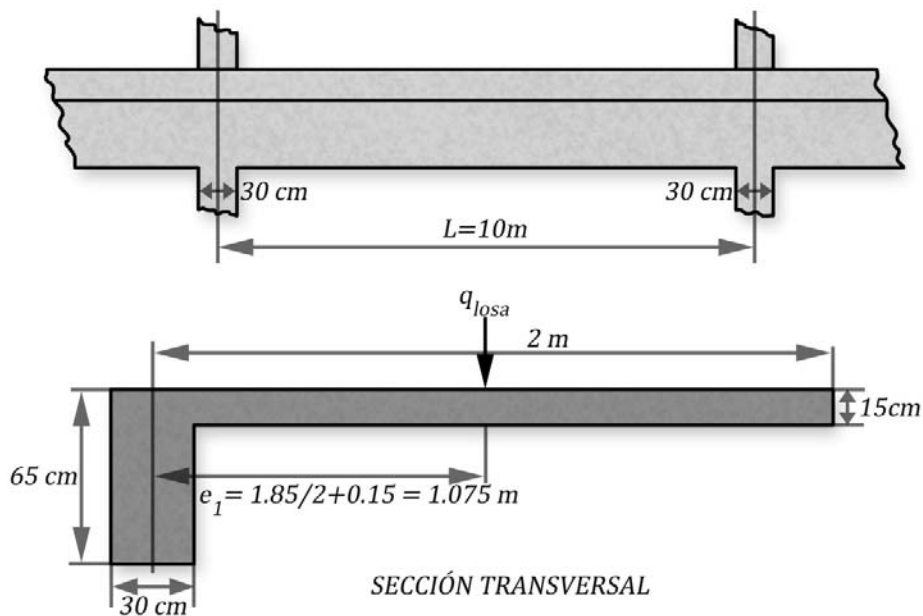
,17: Secciones de la viga y la losa. Ejercicio.
